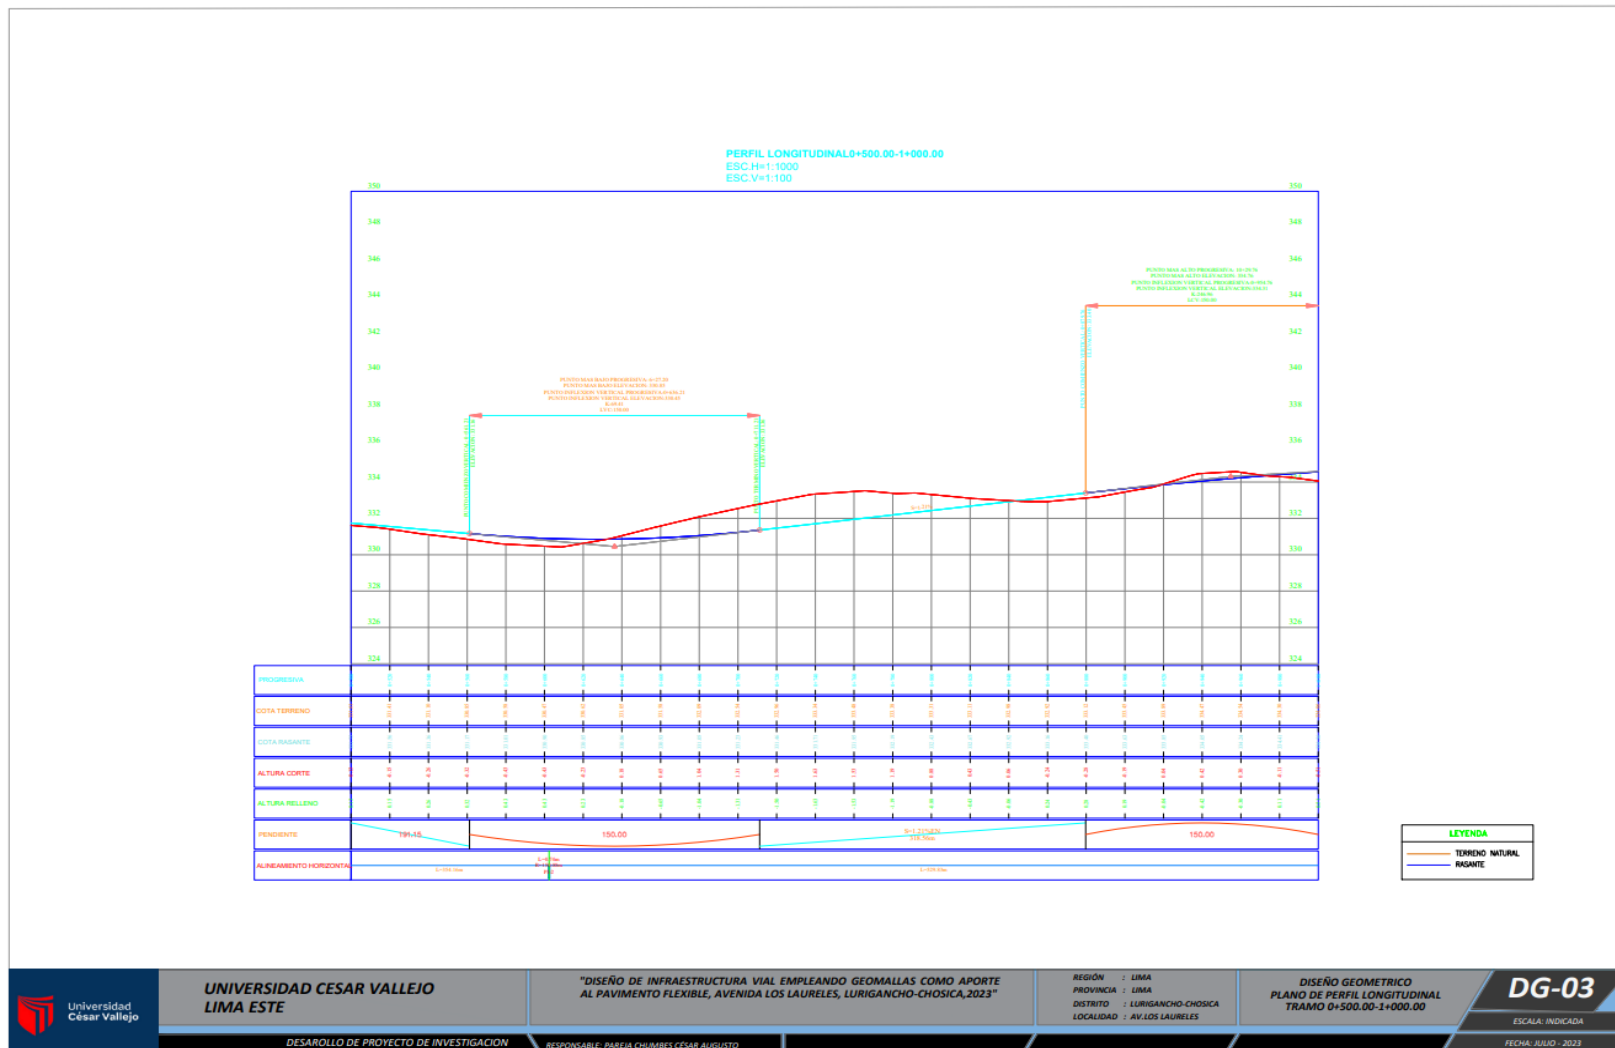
Perfil longitudinal-Av. Los Laureles
